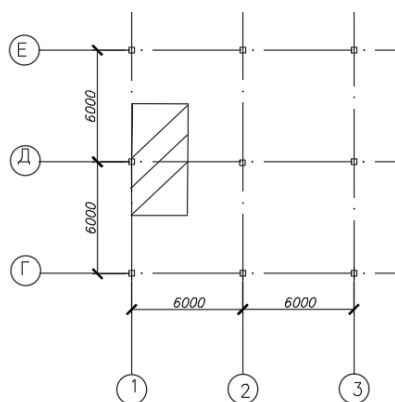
Грузовая площадь наиболее нагруженной крайней колонны
